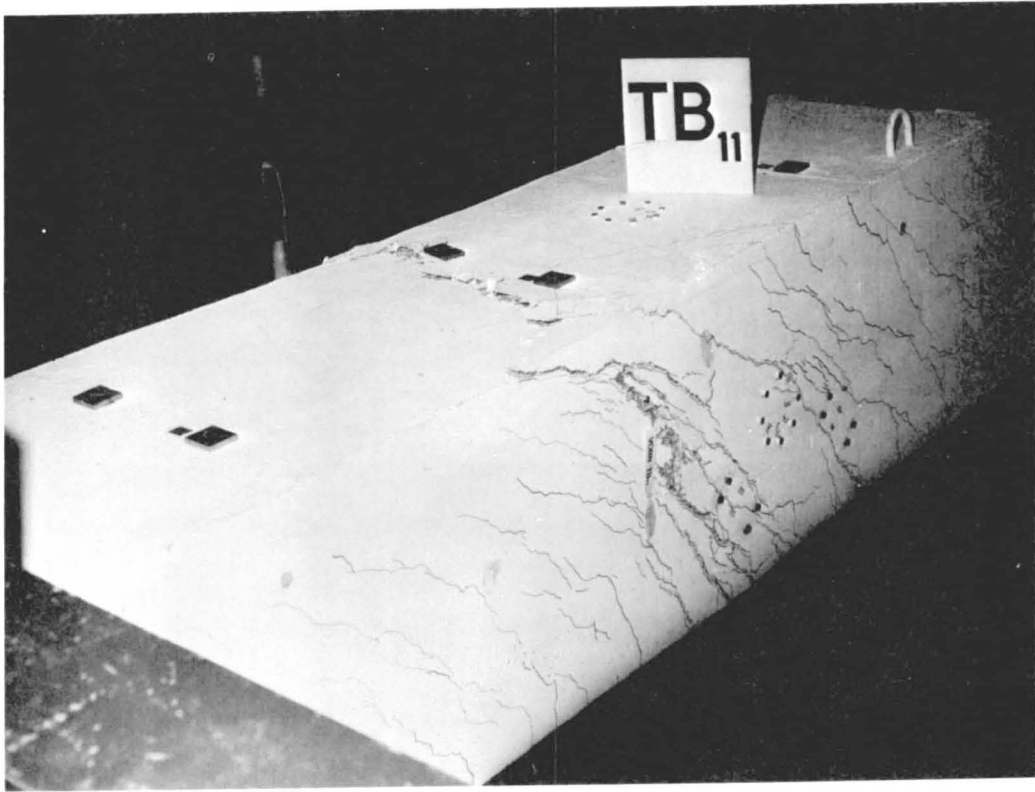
(a): Bruchbereich Balken TB₁₁ (oben, vorn)
